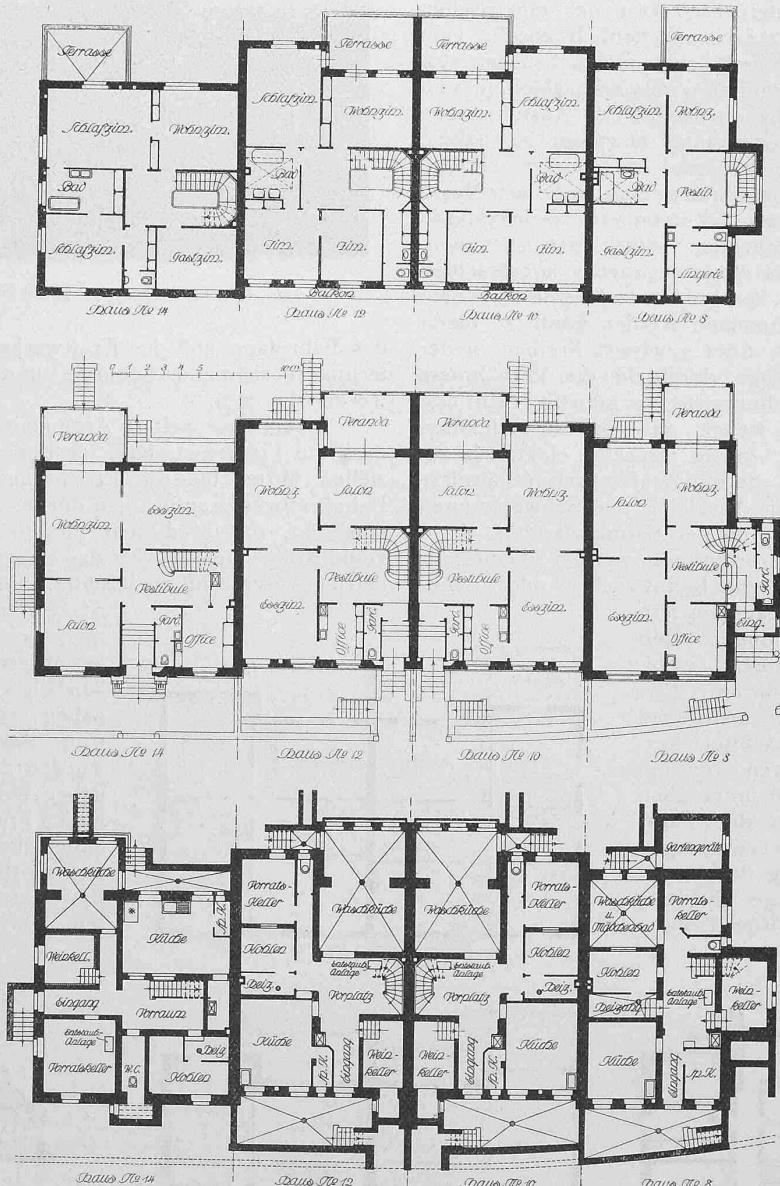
bis 12. Grundrisse der Häuser Lautengartenstrasse Nr. 8 bis 14
